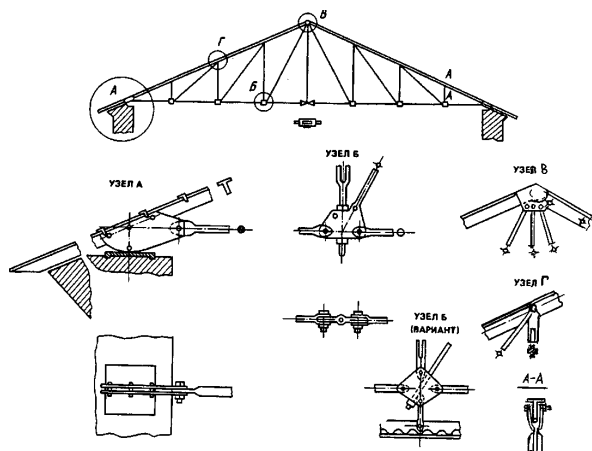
Стропильная ферма (70-е годы XIX века)
